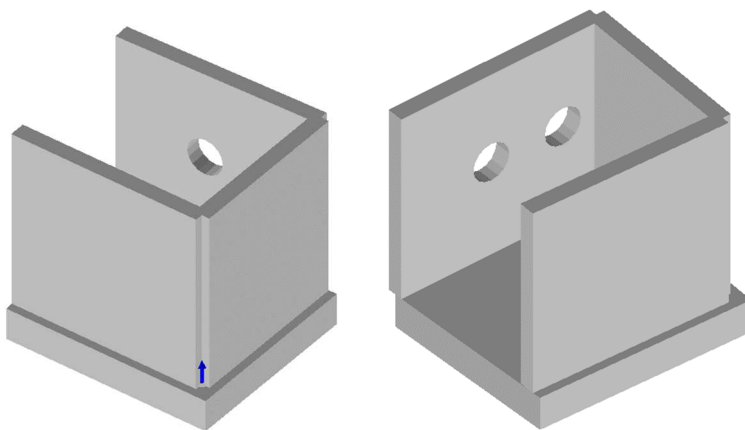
Vista solida del manufatto e della sua struttura di fondazione oggetto di verifica
